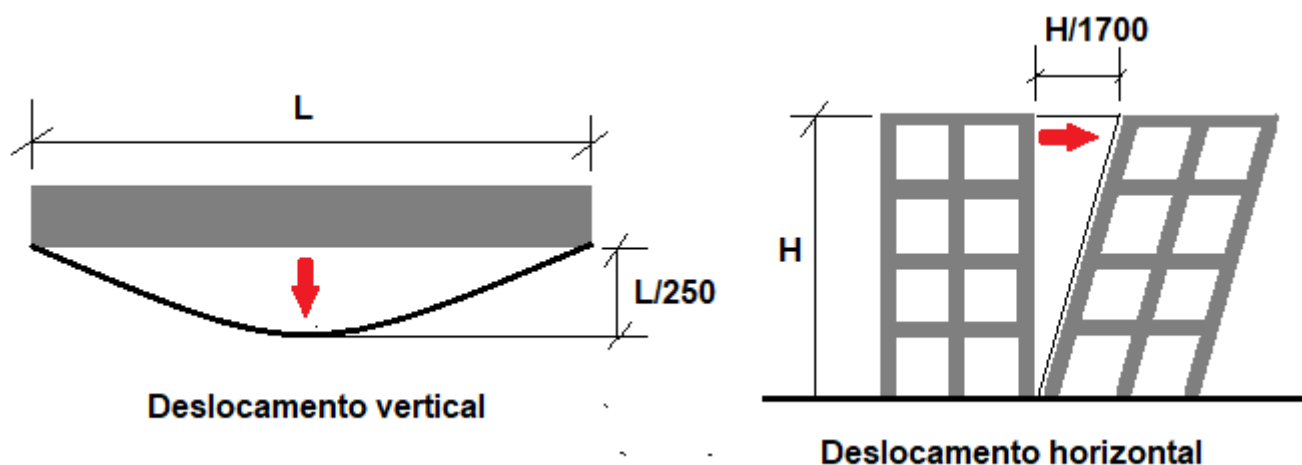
Exemplos de deslocamentos em estruturas de concreto armado.
